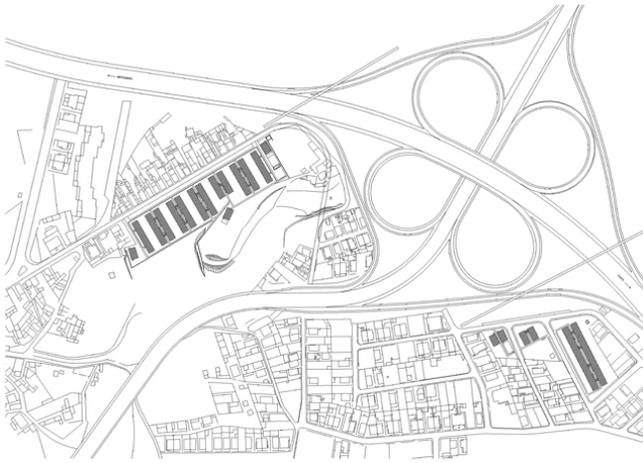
Repetición, proporción, orden y ritmo en la planta general del Conjunto de la Rua Seara. Plano del archivo original de João Álvaro Rocha.
